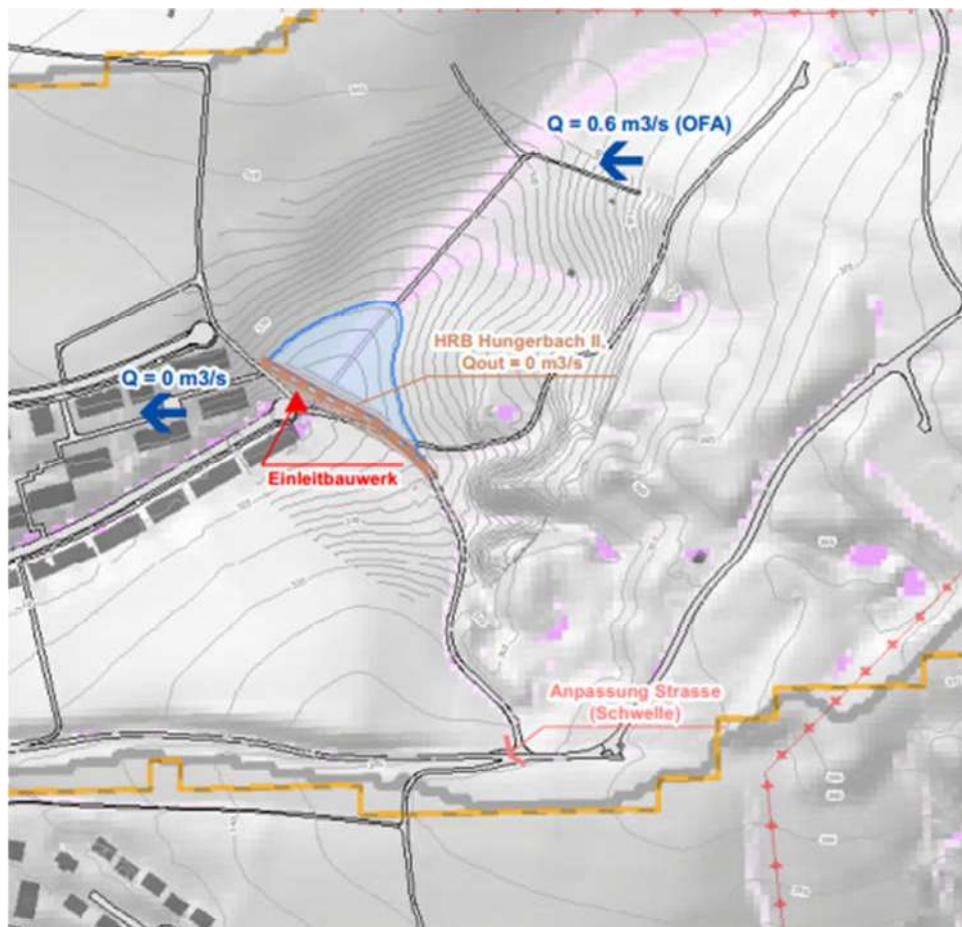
Ausschnitt aus dem Situationsplan Variante 4
